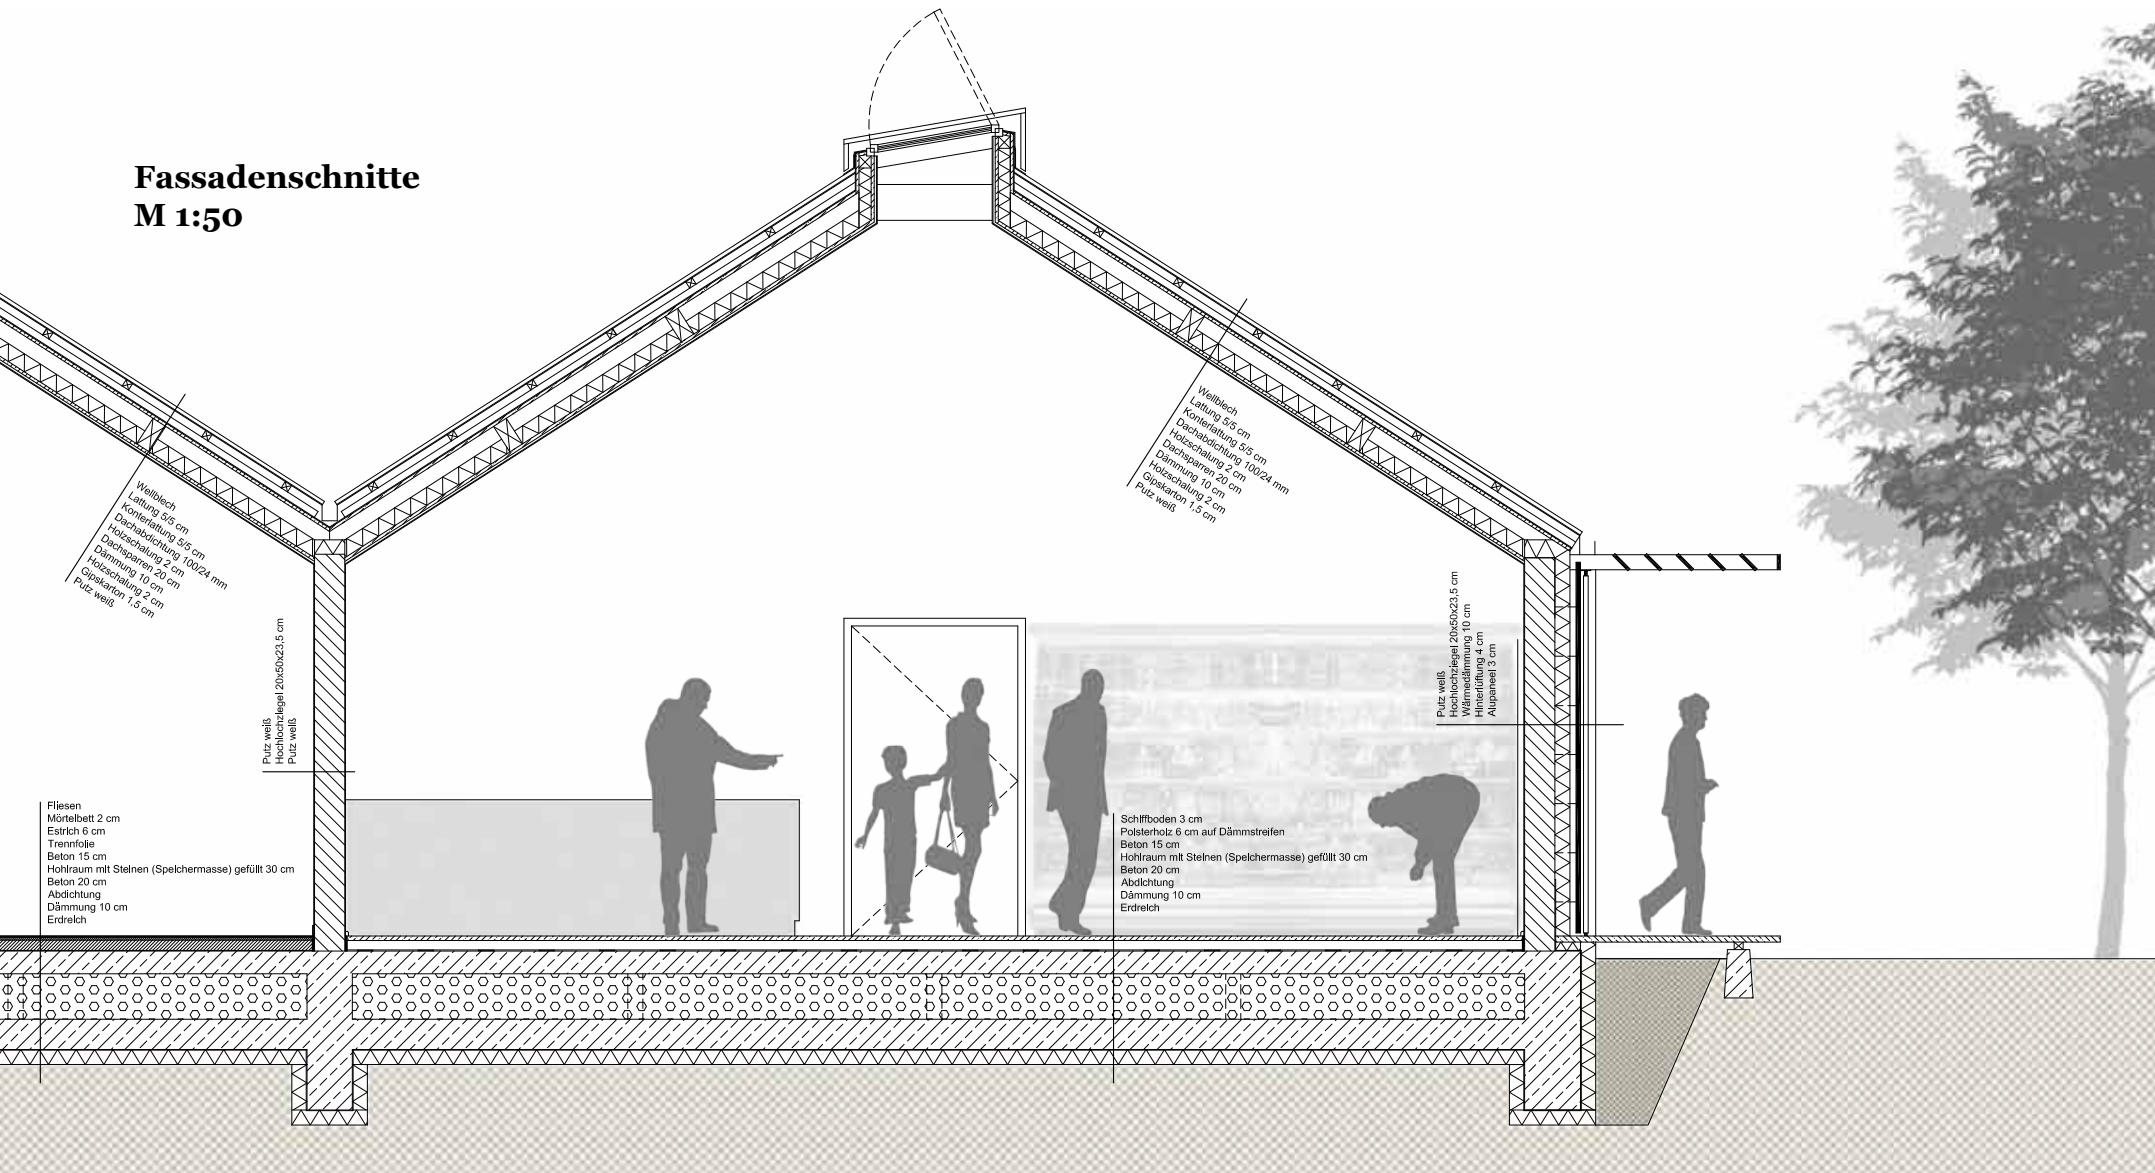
Fassadenschnitt durch den Verkaufsbereich und den Haustechnikraum des Wohnhauses
